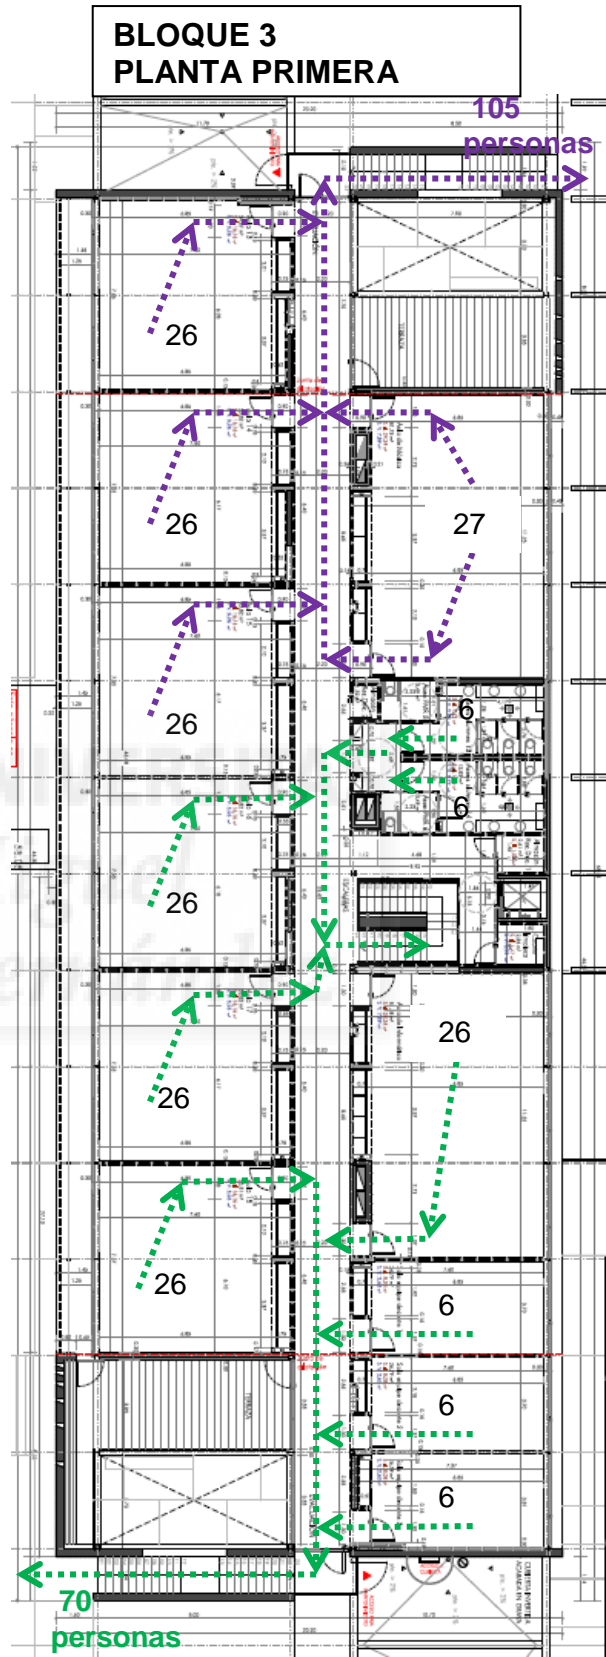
Plano Bloque 3, Planta 1ª, recorridos de evacuación
